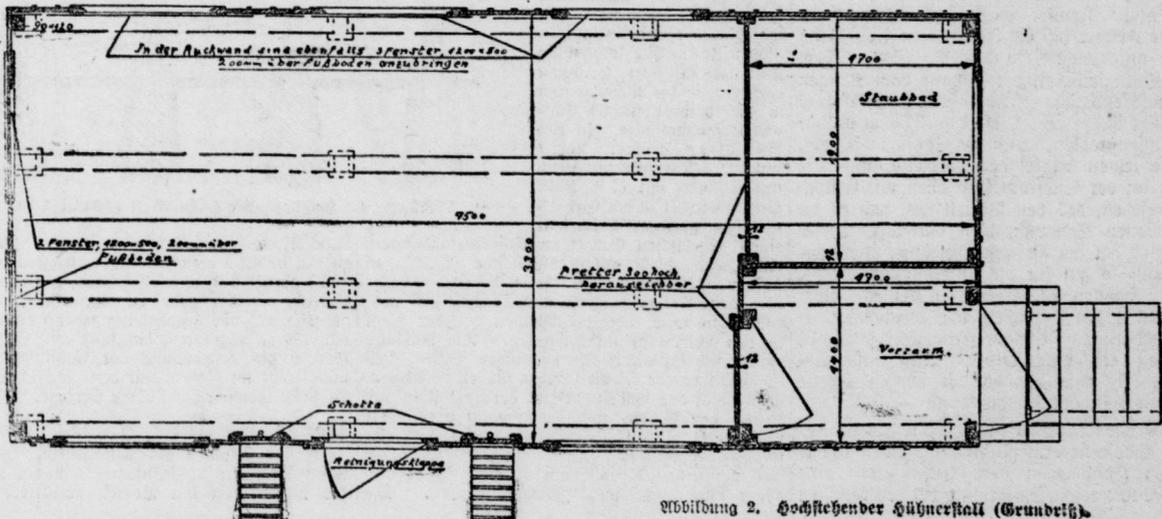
Hochstehender Hühnerstall (Grundriß).
